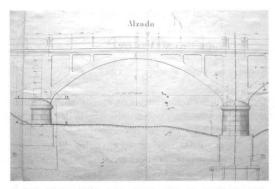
Detalle del vano septentrional del puente según el proyecto de reconstrucción de 1942 (Álvarez 1942)
